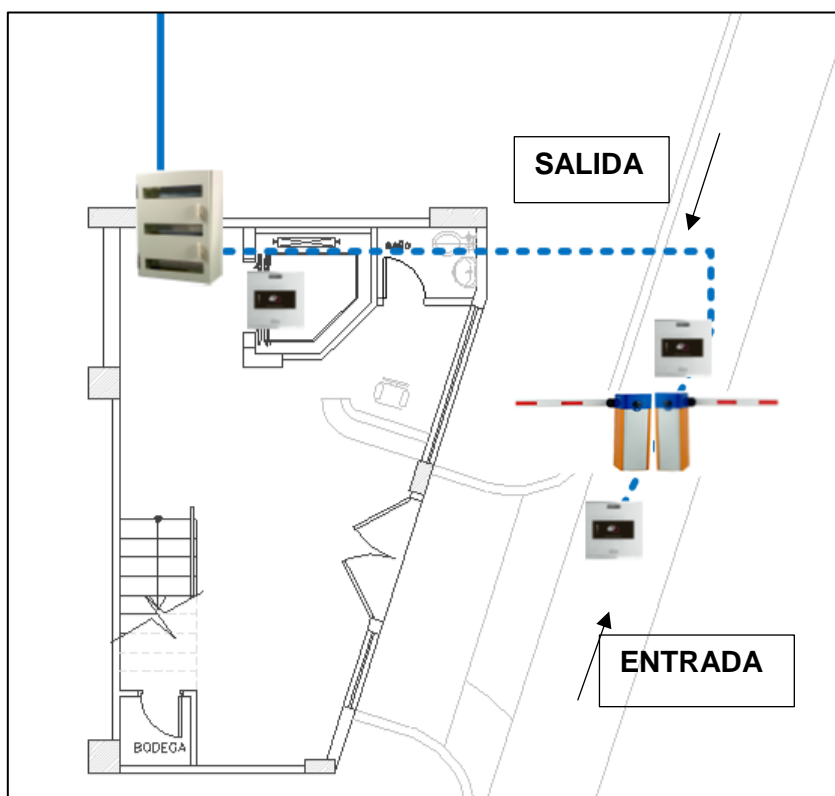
Ubicación de equipos para control de acceso en planta baja y garita
